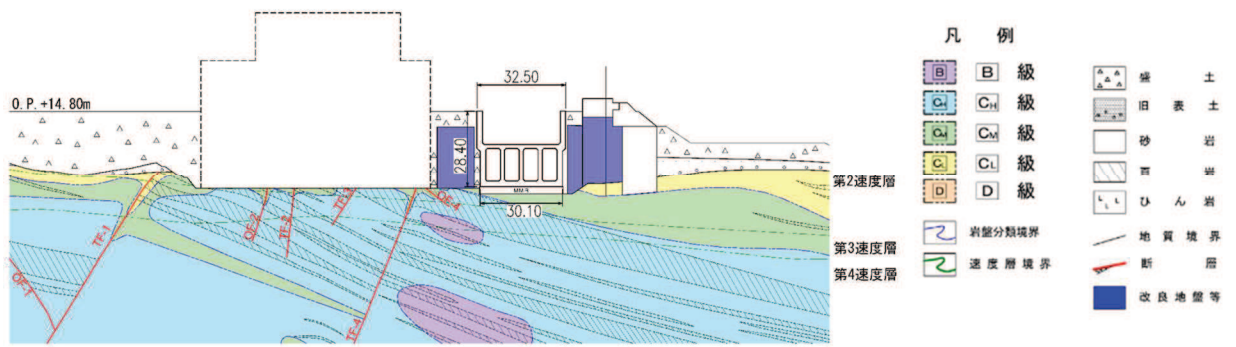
地盤改良体の配置図（海水ポンプ室横断，C-C 断面）
